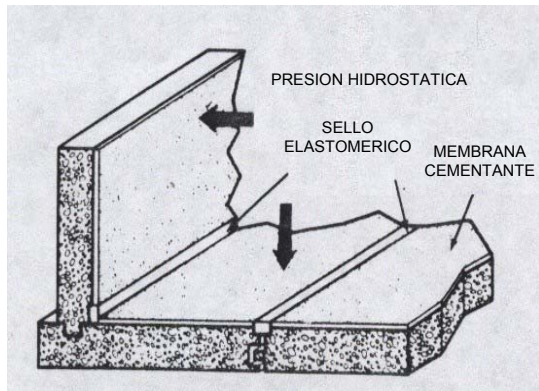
Vista Esquemática del lado positivo, membrana cementante impermeabilizante. Fuente: ACI 515-1R-79 (85).
